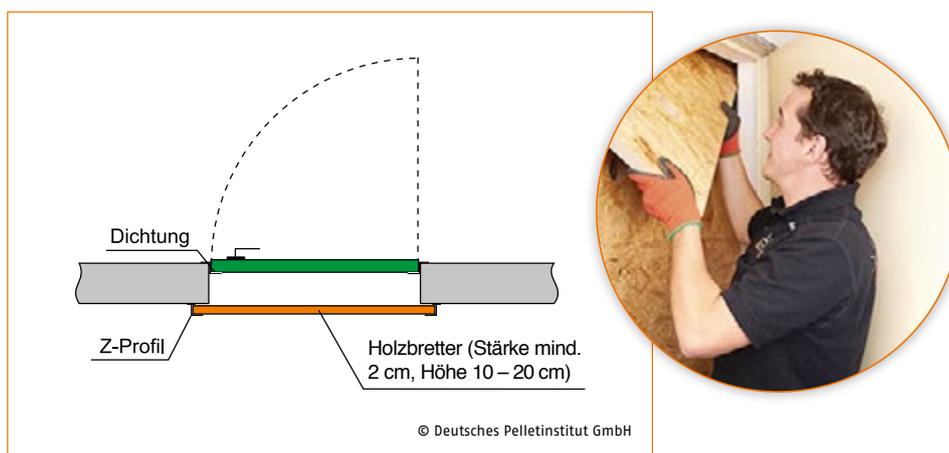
Druckentlastung der Zugangstür/-luke bzw. Einstiegsöffnung (Draufsicht)
